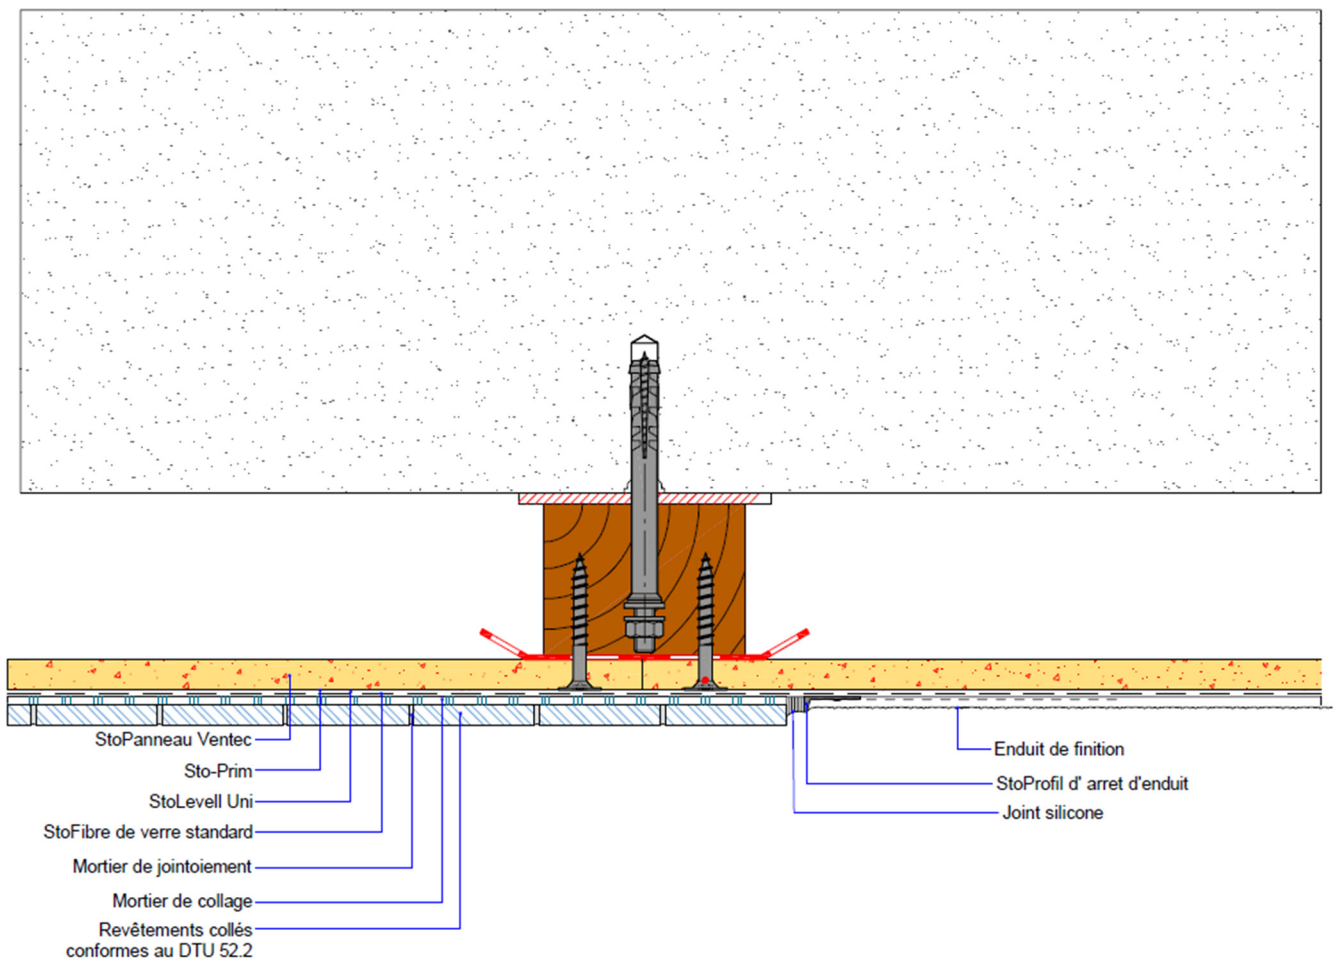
Traitement de la jonction entre système d'enduit et parement collé sur plaque courante
